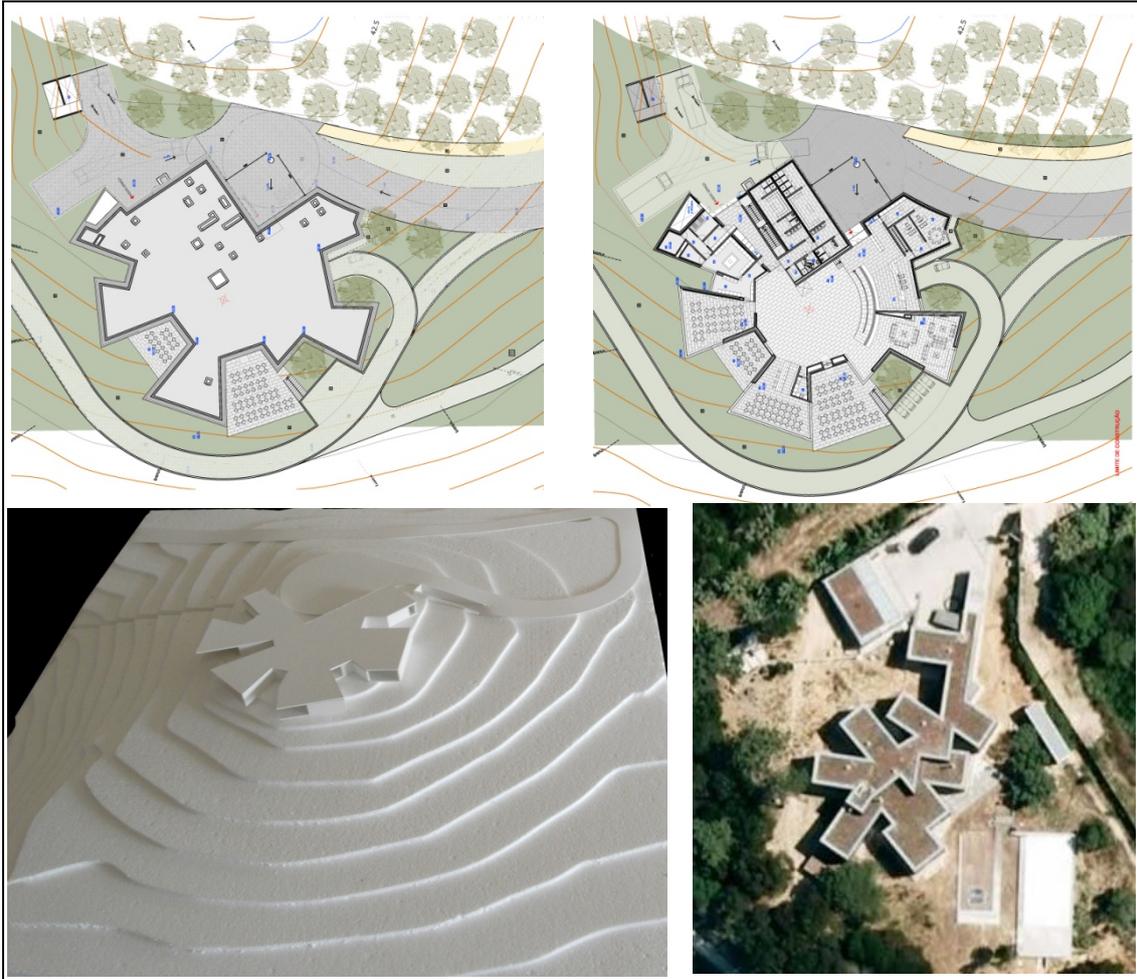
Em cima planta de cobertura e planta do piso do Club House da comporta, em baixo, à esquerda, maquete da versão final do Club House da Comporta e à direita vista aérea da Casa do Pego, de Álvaro Siza
